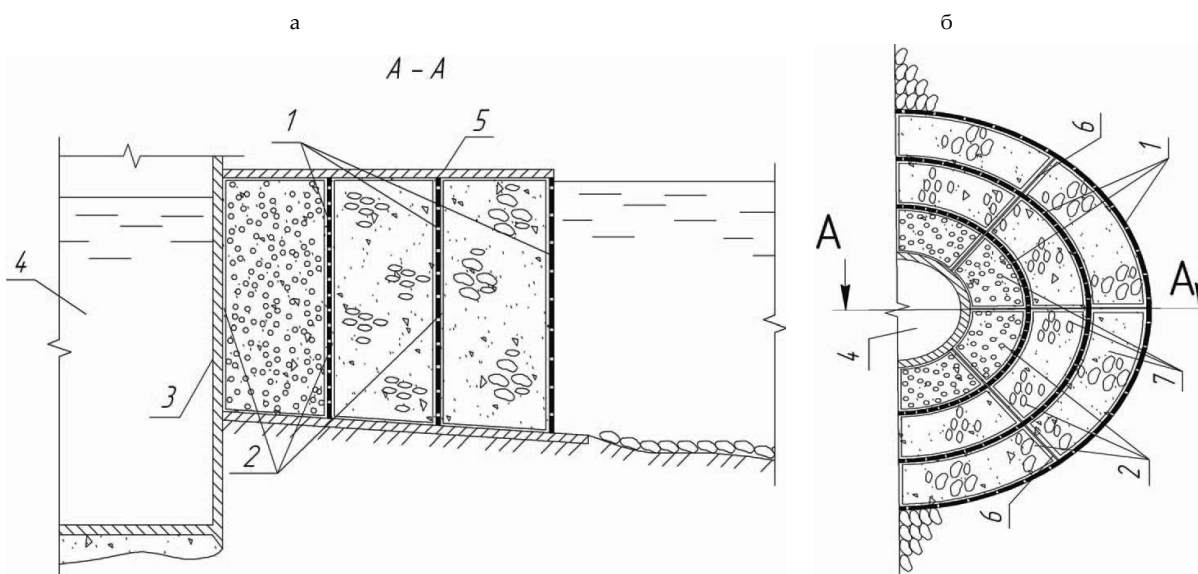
Водоприемно-очистное устройство: а, б - план и разрез ВОС; 1, 6 - перегородки; 2 - фильтрующие секции; 3 - береговая стена; 4 - цилиндрический колодец; 5 - крышка; 7 - загрузочные корзины; 8 - перфорированные стенки; 9 - пенополистирольная загрузка
